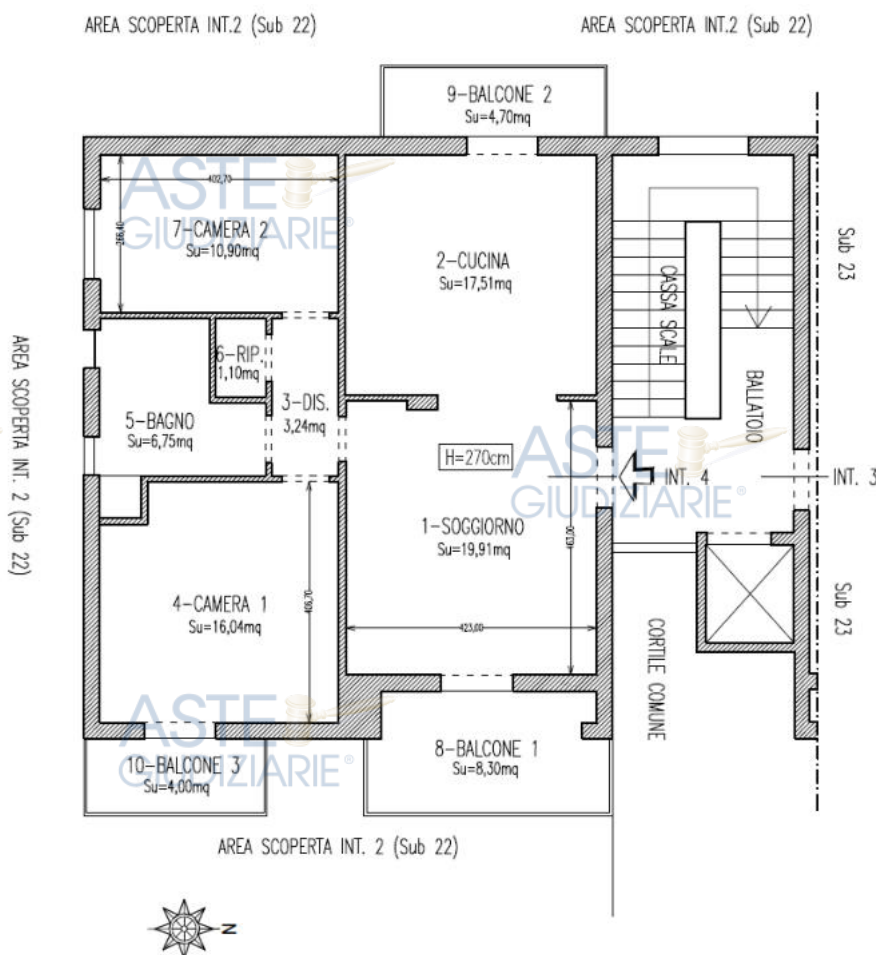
Planimetria di rilievo del BENE 1 - Appartamento.
